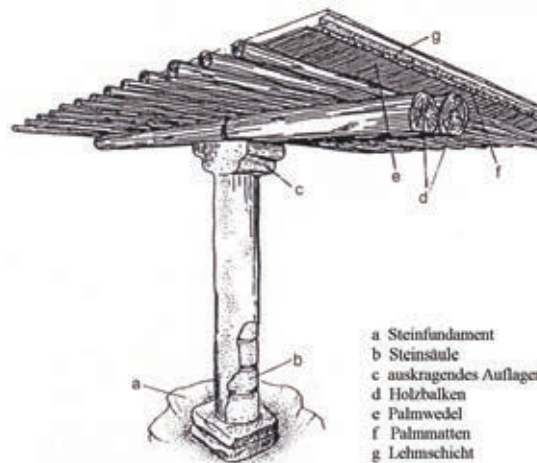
Aufbau einer Geschossdecke mit Holzbalken.
